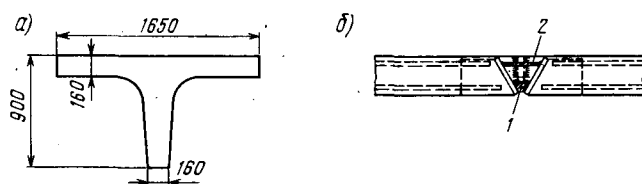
Полносборная железобетонная балка таврового сечения (а) и сварной жесткий стык (б):
